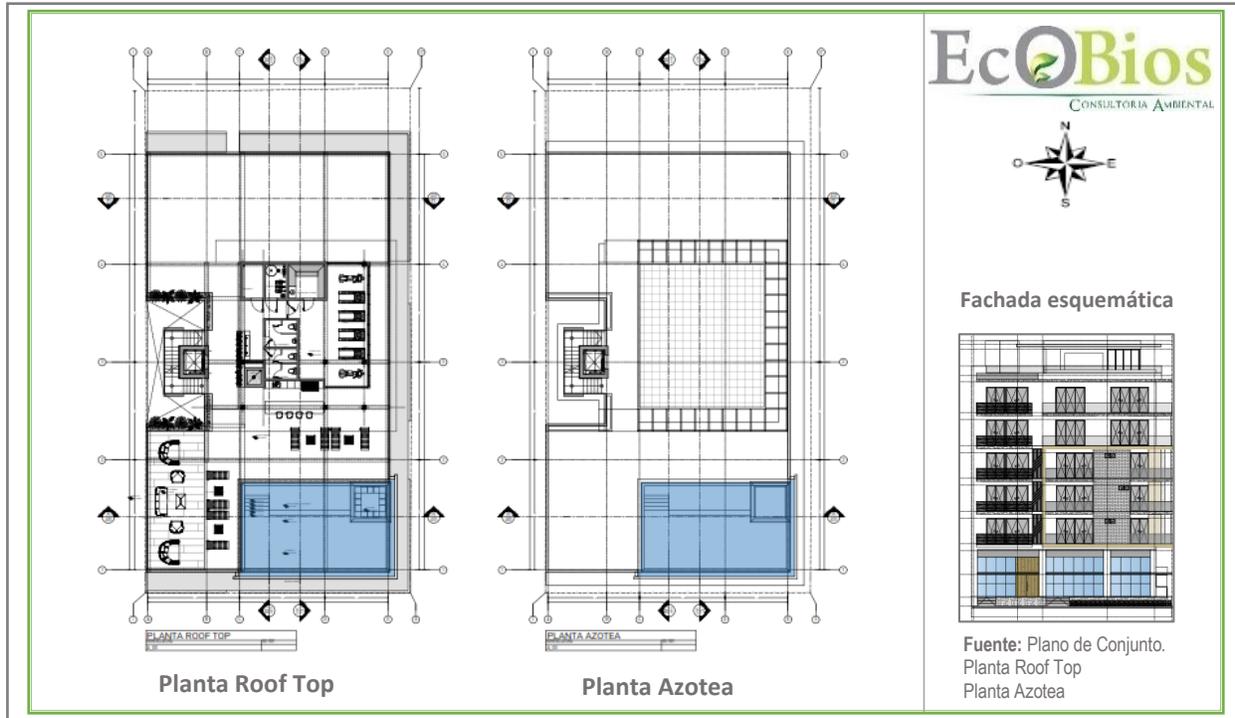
Detalle del diagrama del polígono del Roof Top y Planta Azotea
